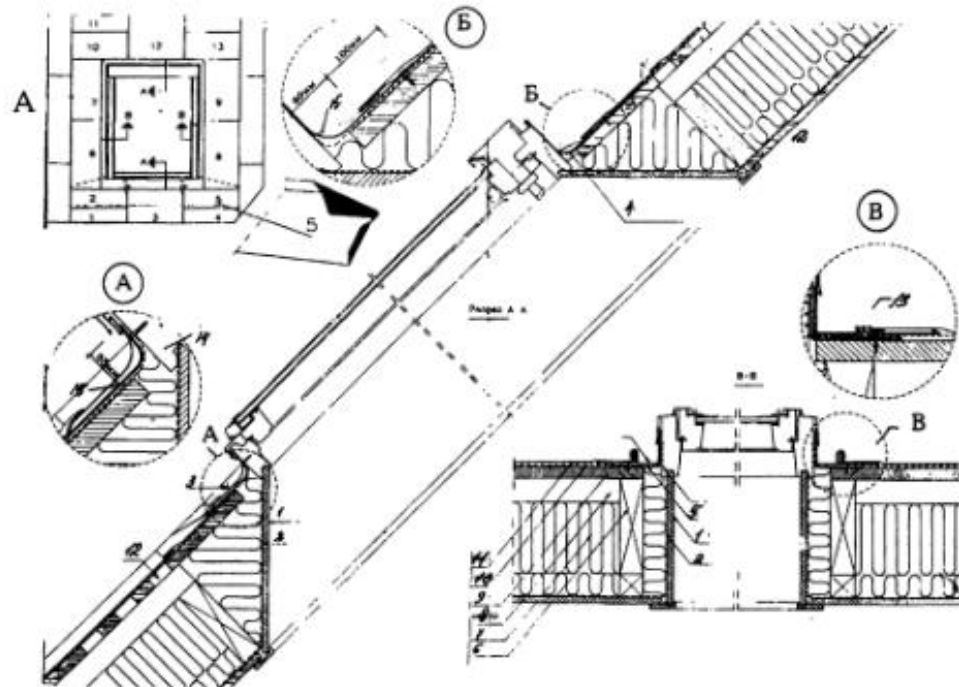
Устройство окон фирмы "Velux" в скате крыши-мансарды (при стальной кровле): А - фасад окна с порядком установки и крепления (1-13) кровельных листов; 1 - оконная панель; 2 - паронизация; 3 - нижняя секция металлического оклада оконного блока; 4 - то же, верхняя секция; 5 - то же, боковая секция; 6 - стропильная нога; 7 - утеплитель; 8 - вентилируемая воздушная прослойка; 9 - обрешетка; 10 - защитная пленка; 11 - металлический лист кровли; 12 - поперечные вентиляционные каналы; 13 - клеммы, фиксирующие листы кровли с шагом 300 мм; 14 - оконная рама; 15 - дополнительный металлический лист ("воротник")
